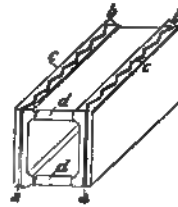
u. 49. Zementhohlsteine mit Eiseneinlagen.
